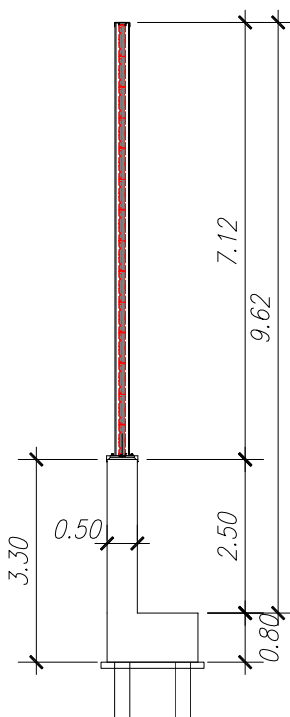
Sezione tipo barriera antirumore ML10 su rilevato
